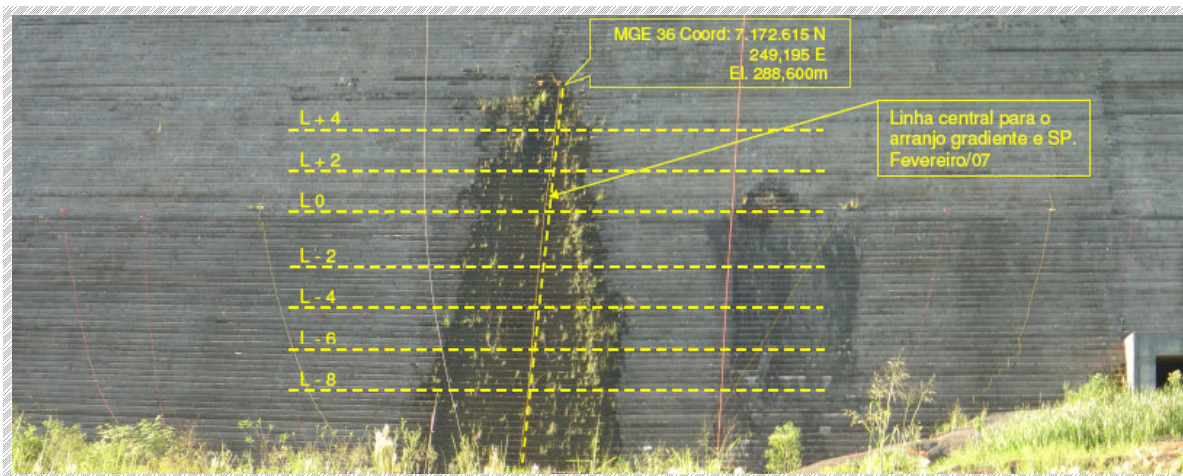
Disposição das linhas de ensaio para arranjo gradiente. UHE GJR. Fevereiro/07.
